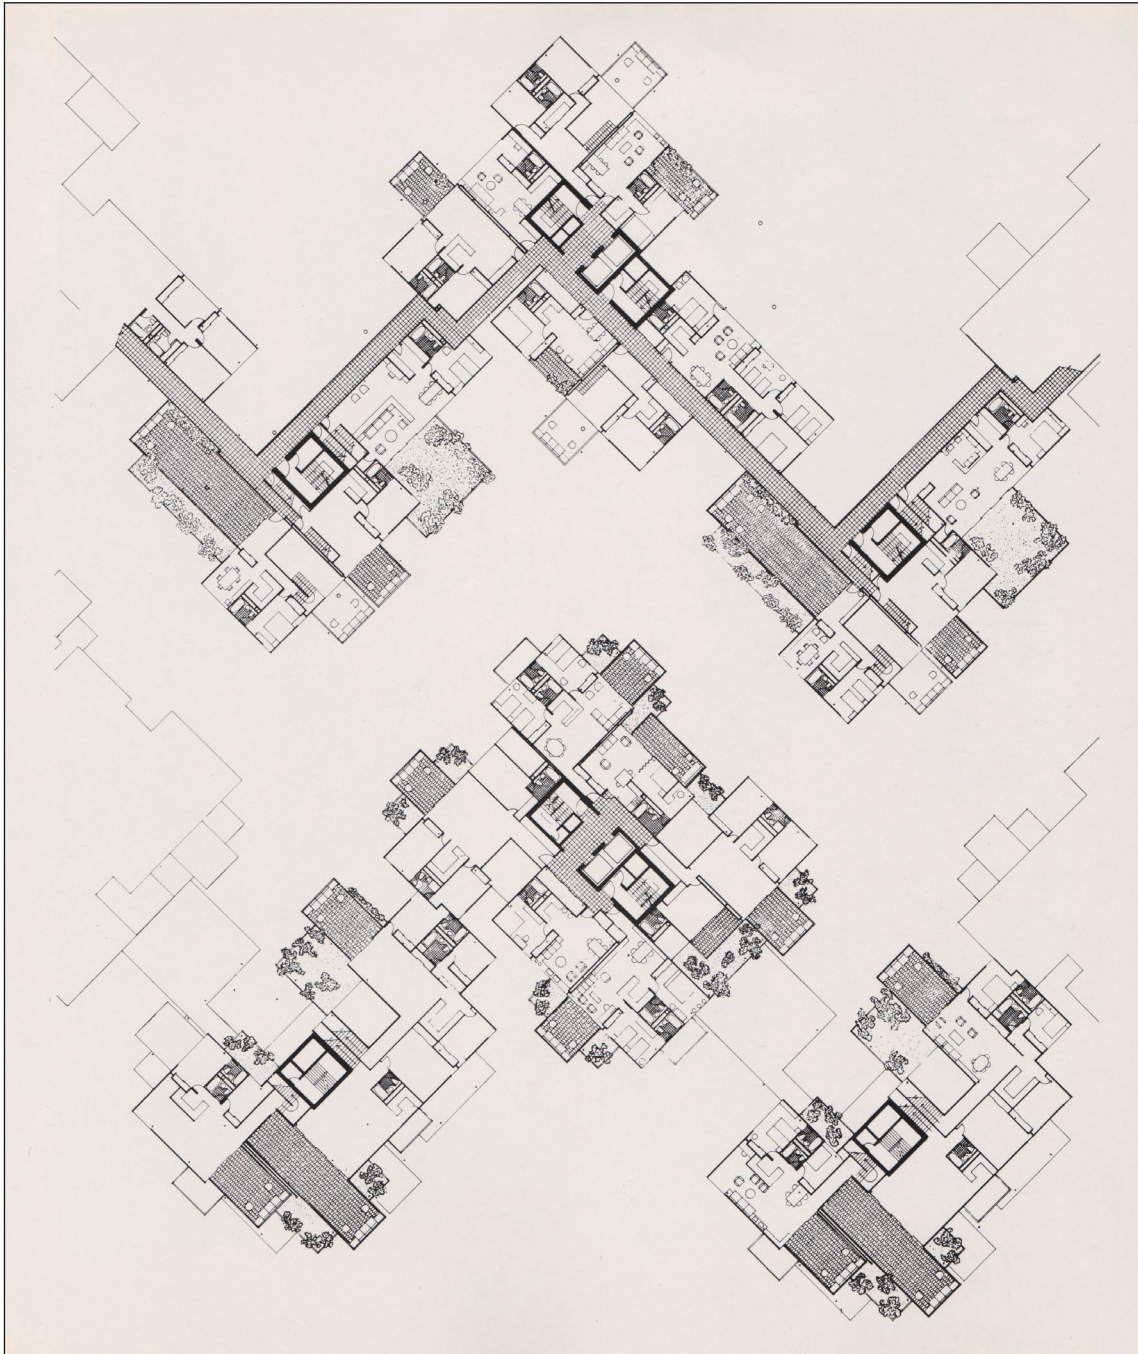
Grundrissausschnitt von zwei übereinanderliegenden Wohngeschoßen. Im oberen Stockwerk (oben) sind die Erschließungskerne mit Passagen verbunden. | Graphic Arts Center, New York, 1967
